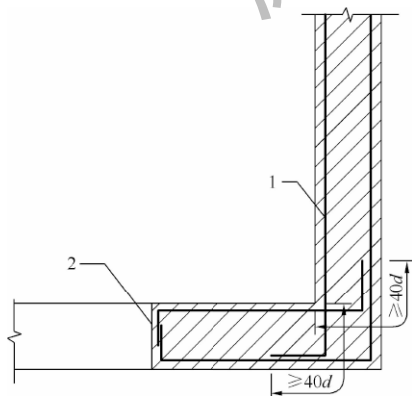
配筋砖圈梁交接处和转角处钢筋搭接
